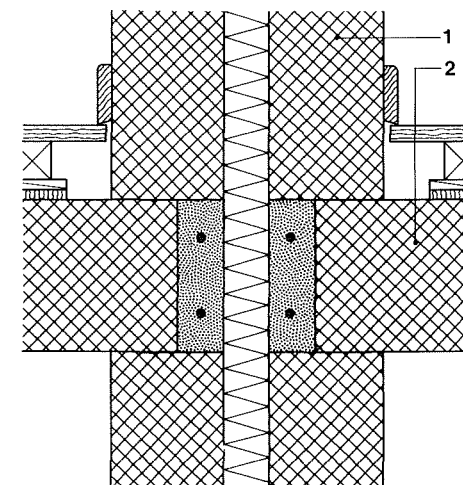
Samling mellem betondæk og dobbelt murstensvæg. Lodret snit 1:10.
